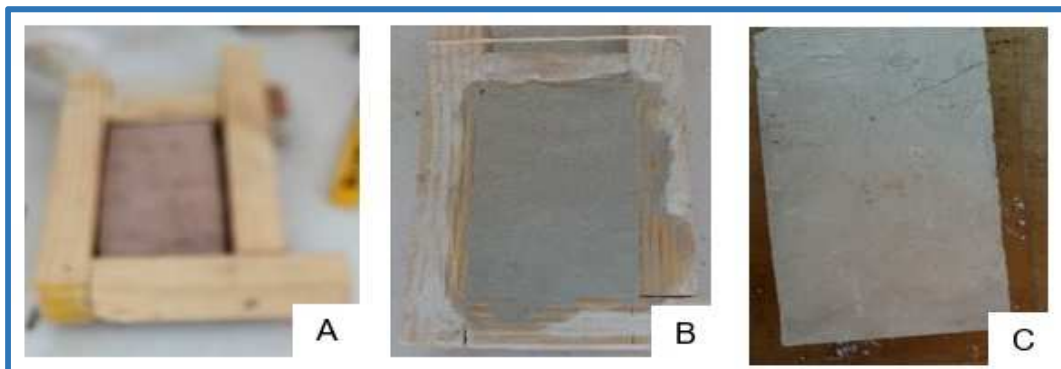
A) Molde para cabeceo, B) Ladrillo con pasta para cabecear, C) Ladrillo cabeceado
